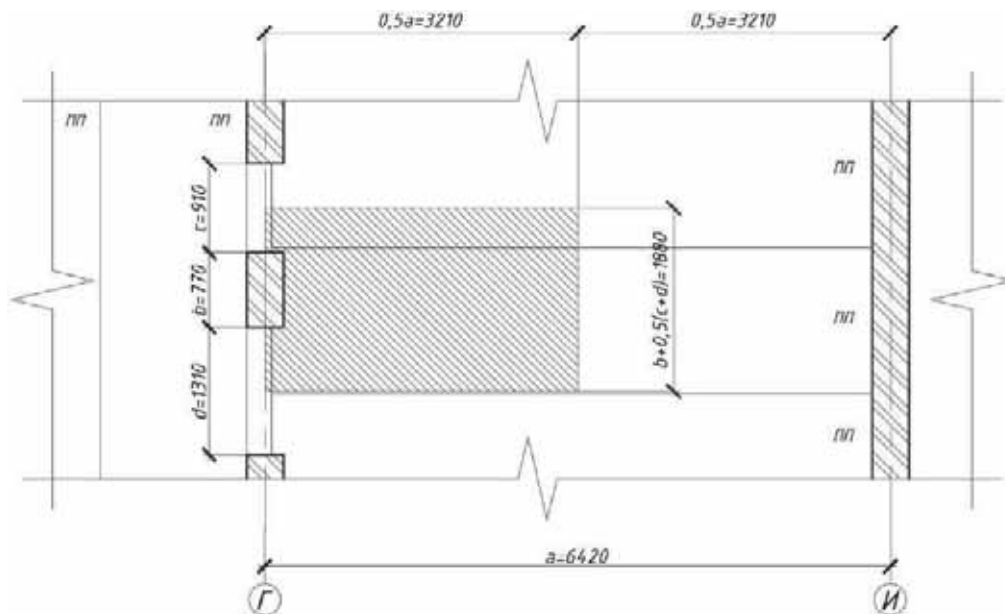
Определение грузовой площади покрытия (перекрытия).
